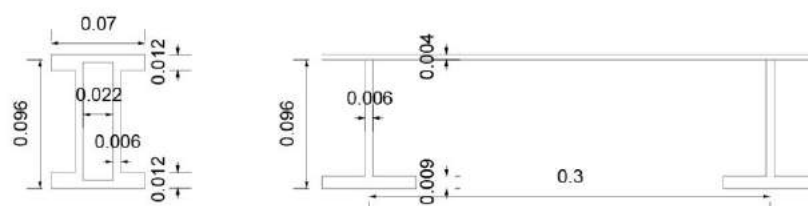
Piezas estructurales de Forjado de planta alta [40]
